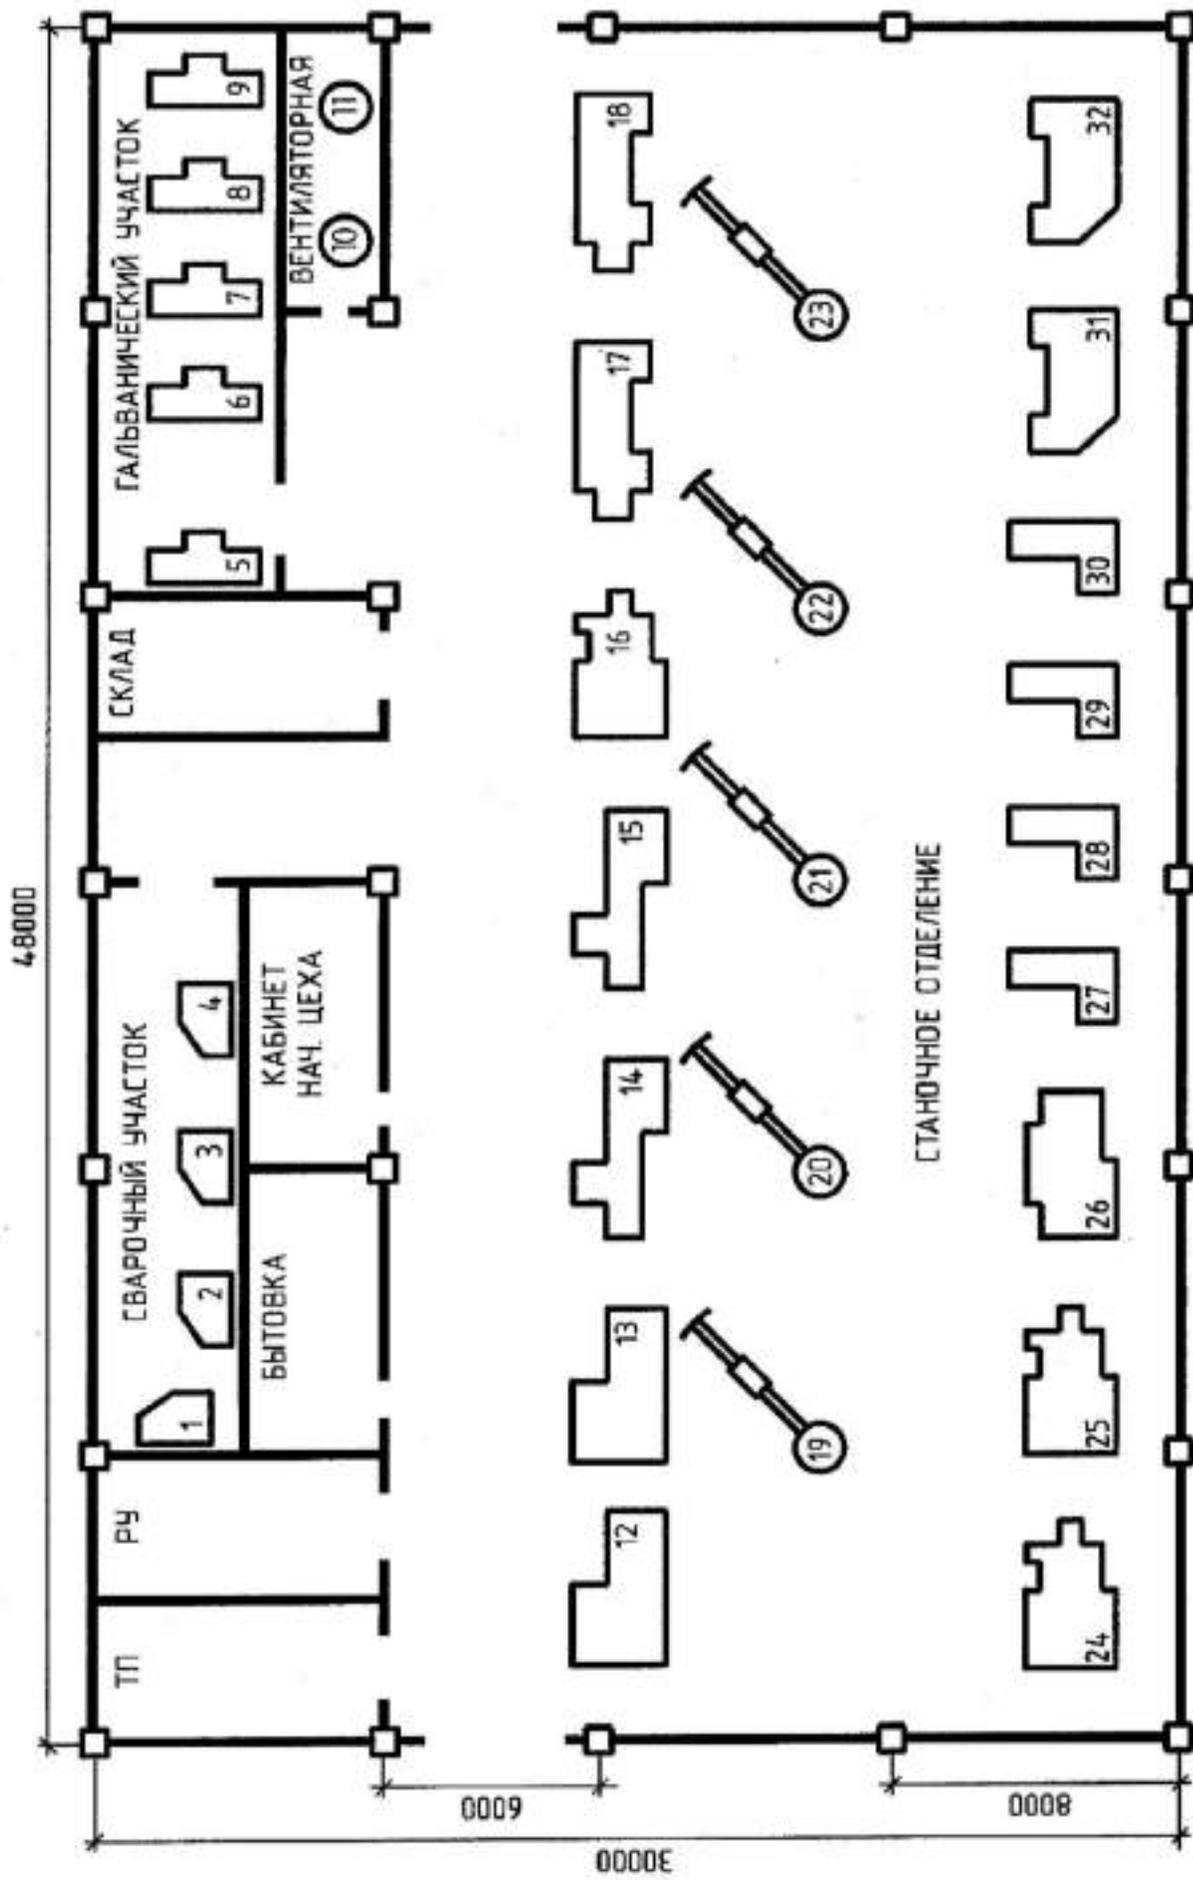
План расположения ЭО цеха обработки корпусных деталей
